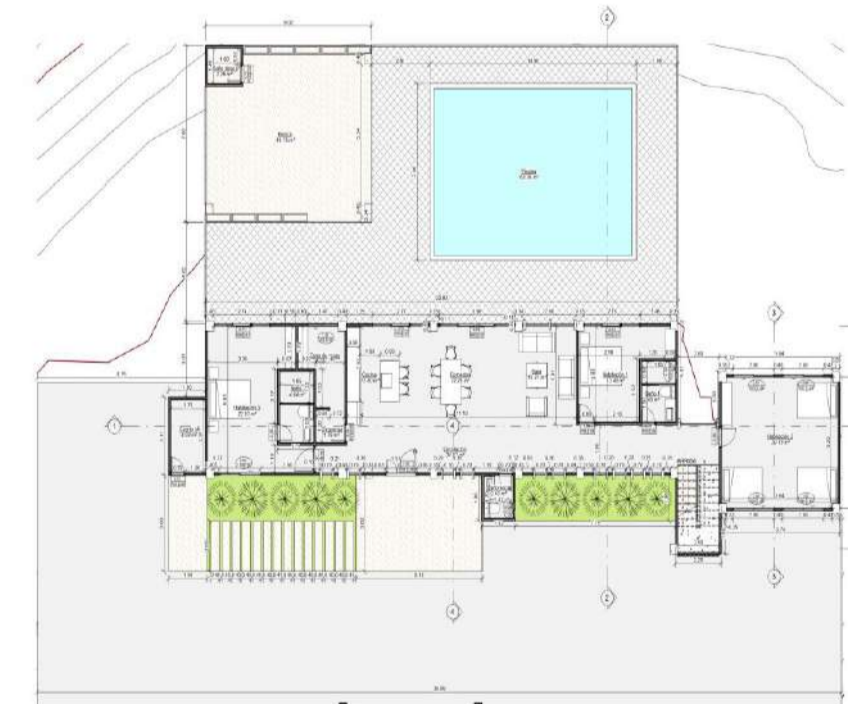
Elaboración propia Fuente. Propuesta final de distribución evidenciada en planta arquitectónica de primer piso Proyecto. Tulpanes
